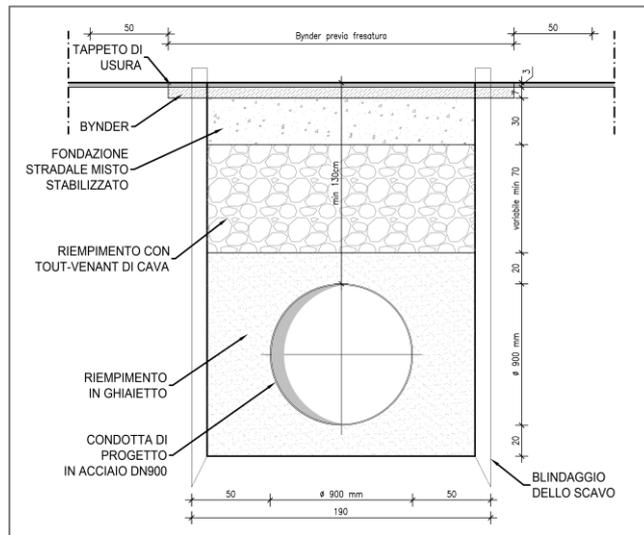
Sezione tipo di posa su strada comunale asfaltata - stralcio 1.
